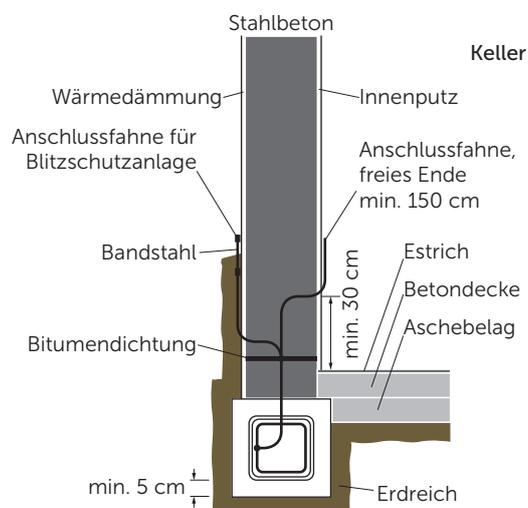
Erdungsanlage Typ B, Fundamenterder
